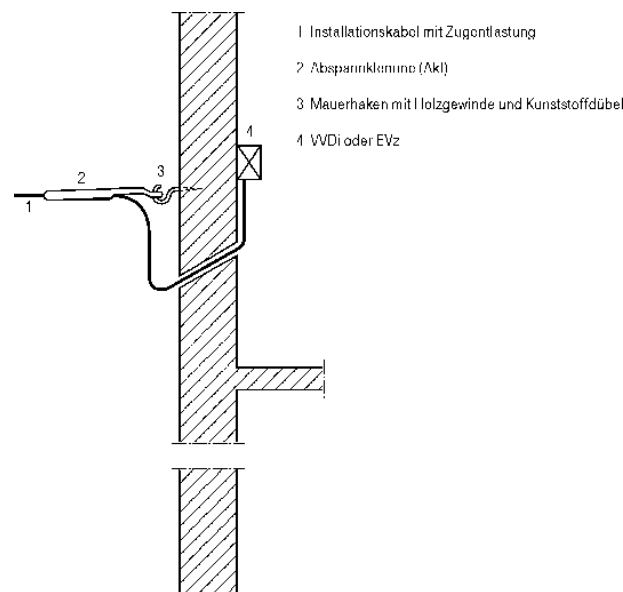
Oberirdische Gebäudezuführung mit Gebäudeeinführung
